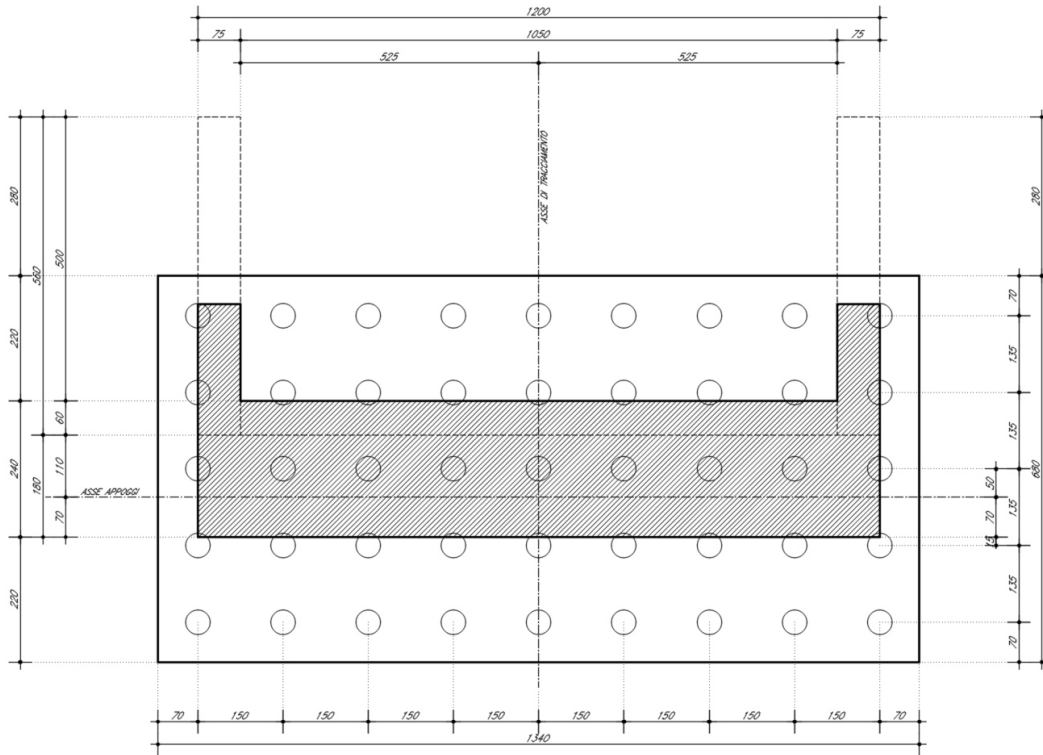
Pianta fondazione e spiccato elevazione spalla B
